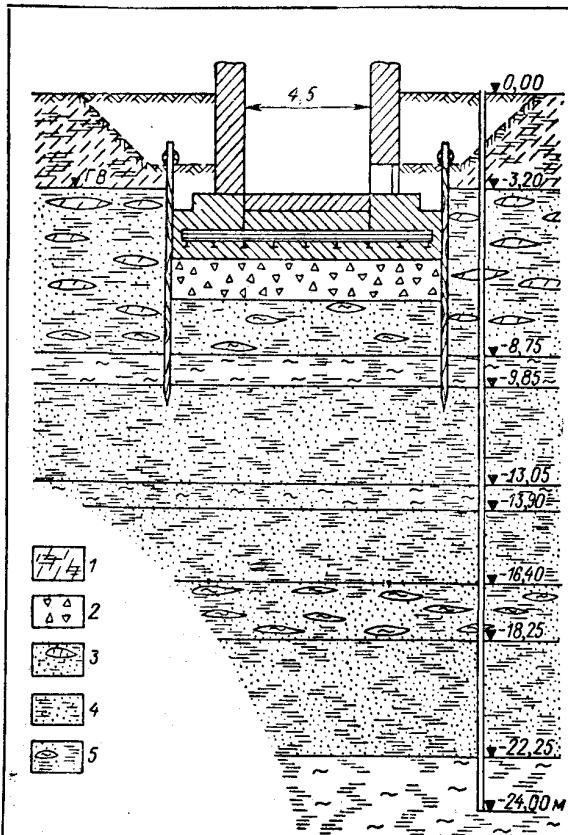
Фундамент, расположенный на пьлуве. В основании фундамента подушка из щебня. Работы выполнялись под защитой шпунтового ряда (по М. И. Евдокимову-Рокотовскому).
